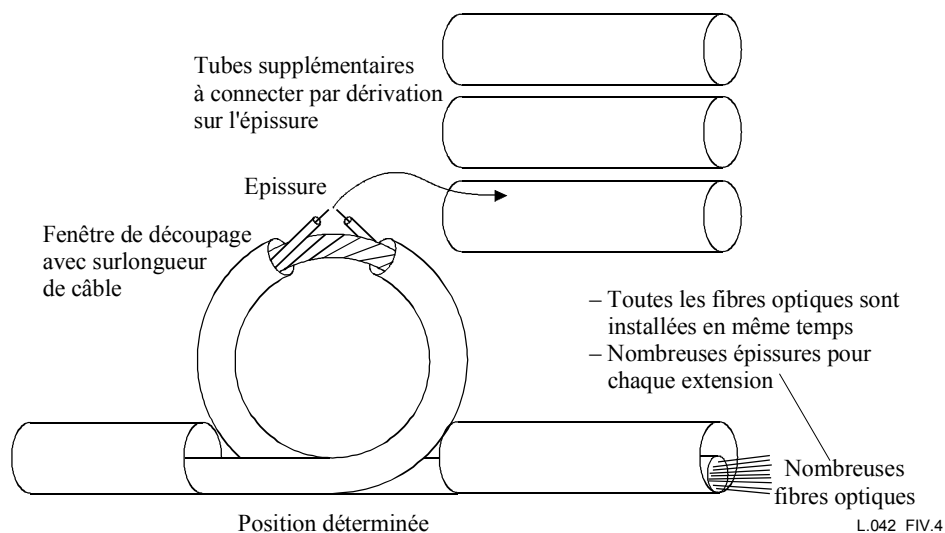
/L.42 – Point d'épissurage avec surlongueur de câble dans le cadre d'un câblage optique classique
